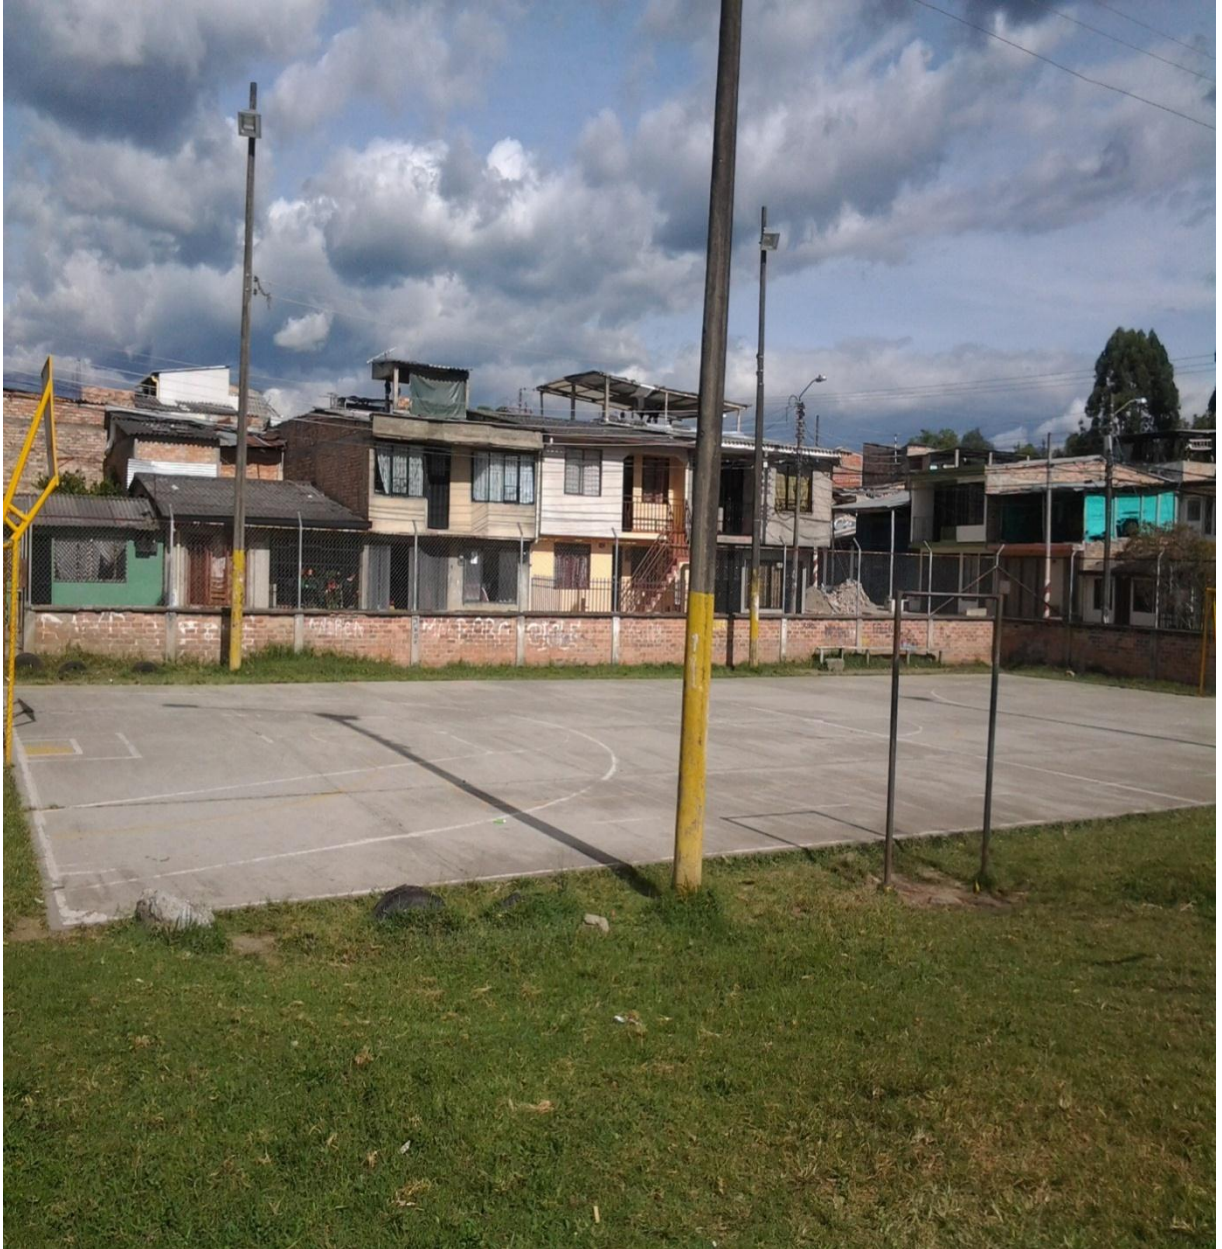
CANCHA EXISTENTE BARRIO CANADÁ – POPAYÁN CAUCA
